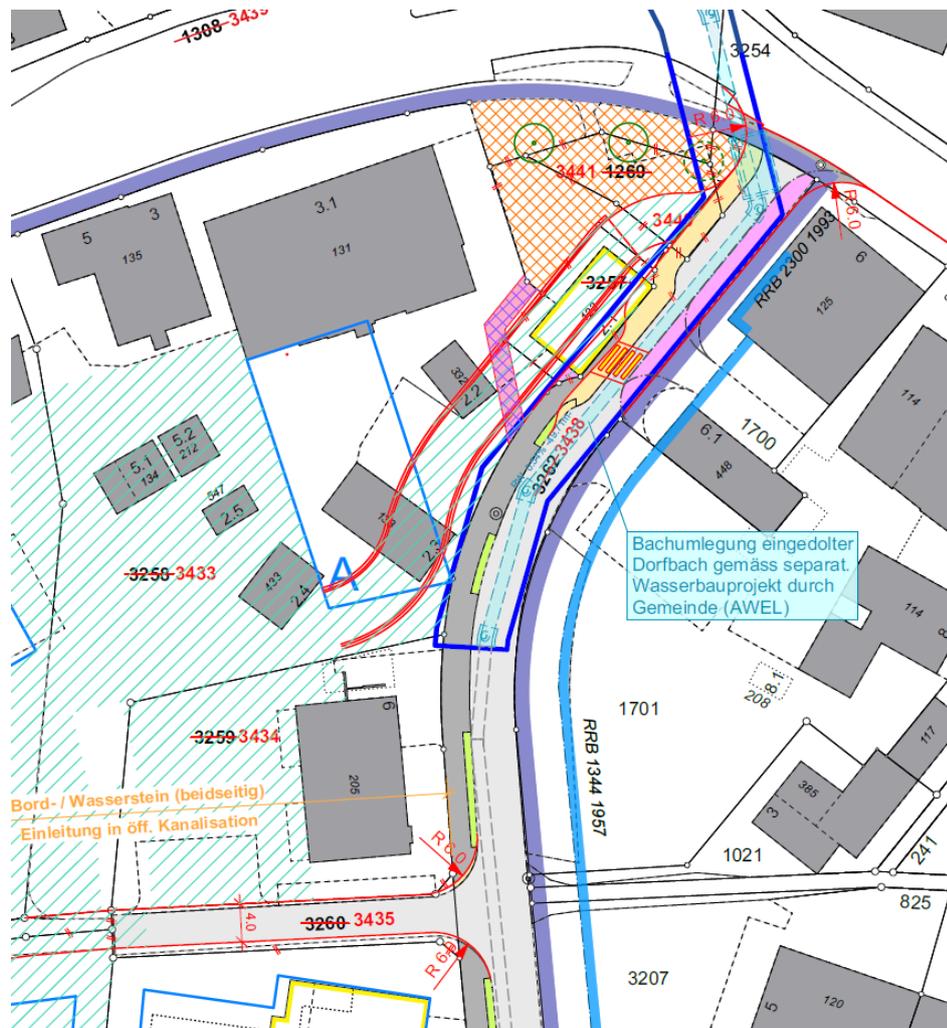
Einfahrtsbereich Tiefgarage Nord, Plan «Erschliessung Strasse»
